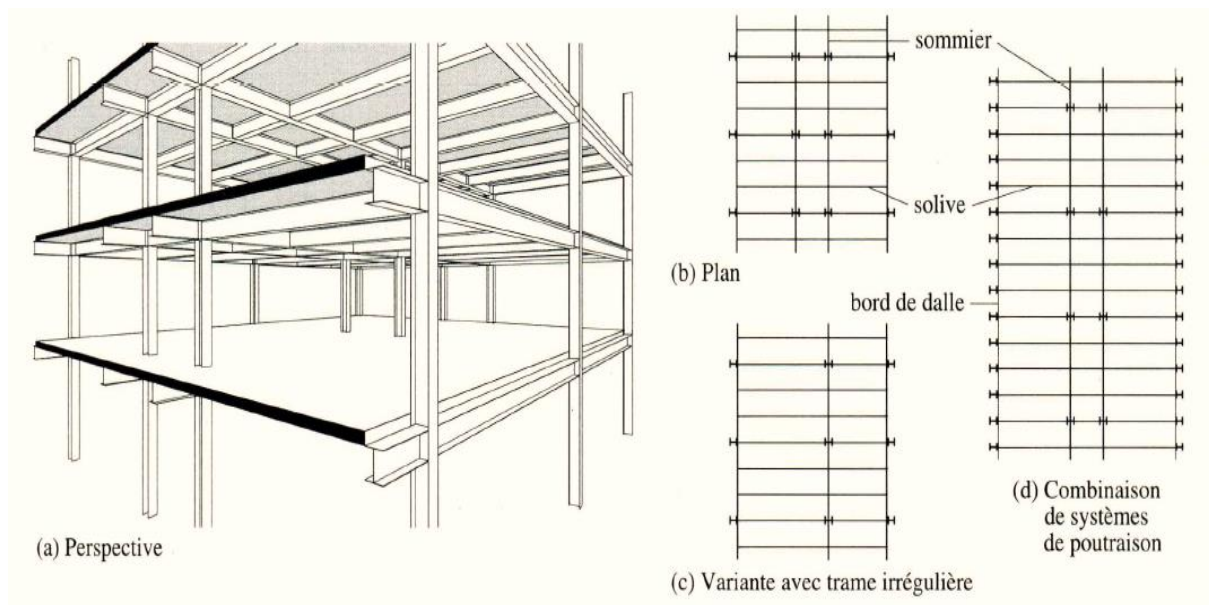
Planchers à deux niveaux de poutres [26]
